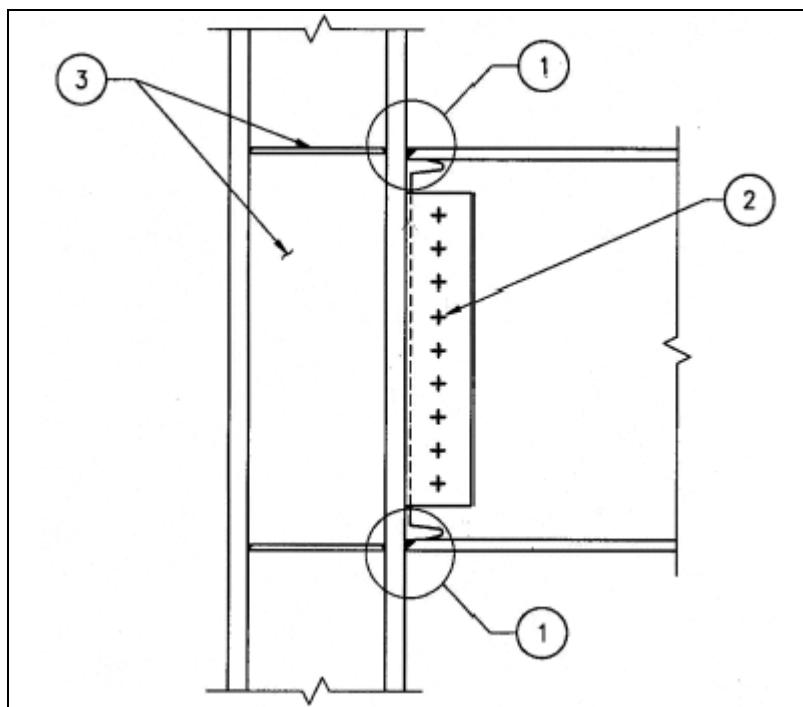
(Detallado de soldadura, plancha de corte y rigidizadores)
